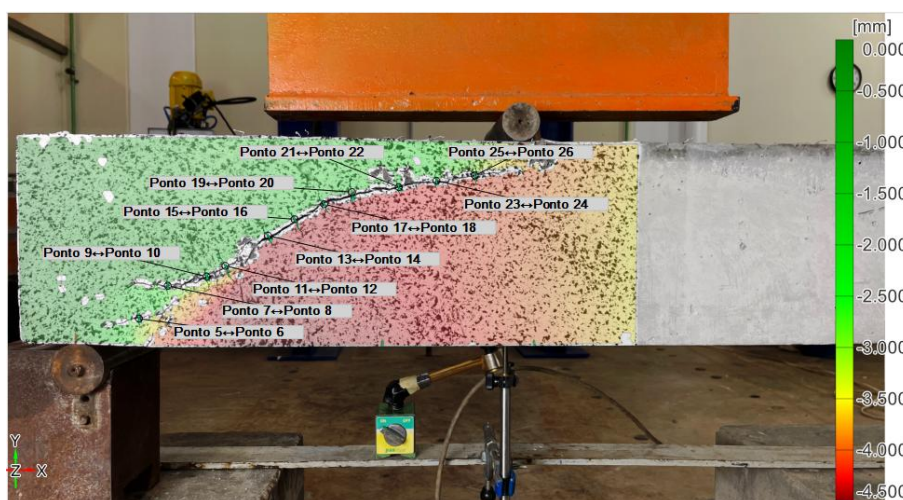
Formação da fissura diagonal - Vigas C70-P-1,0
